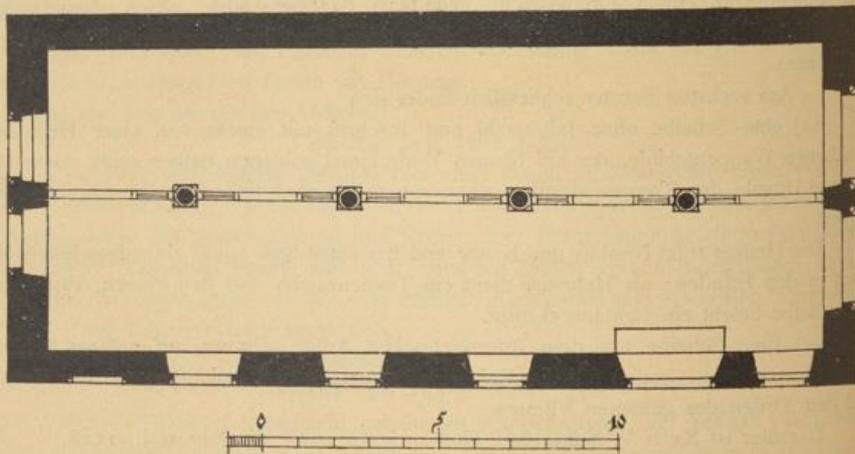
Endingen. Kaufhaus, Grundriss.
